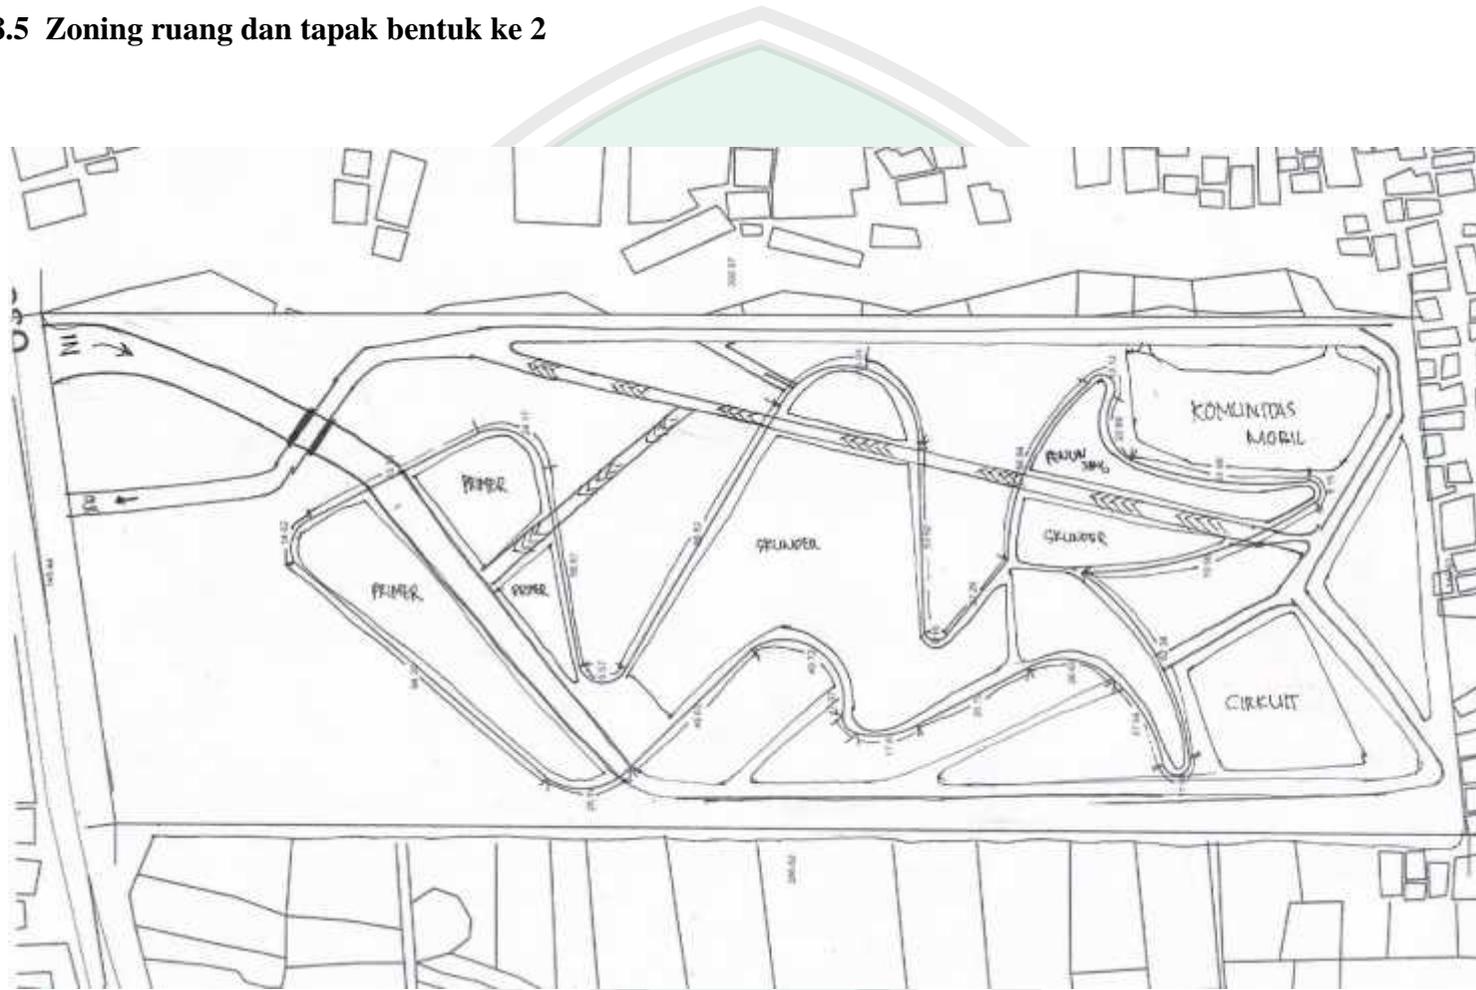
Alternatif blockplan zoning ruang ke 2 (Sumber: Analisis pribadi, 2014)
